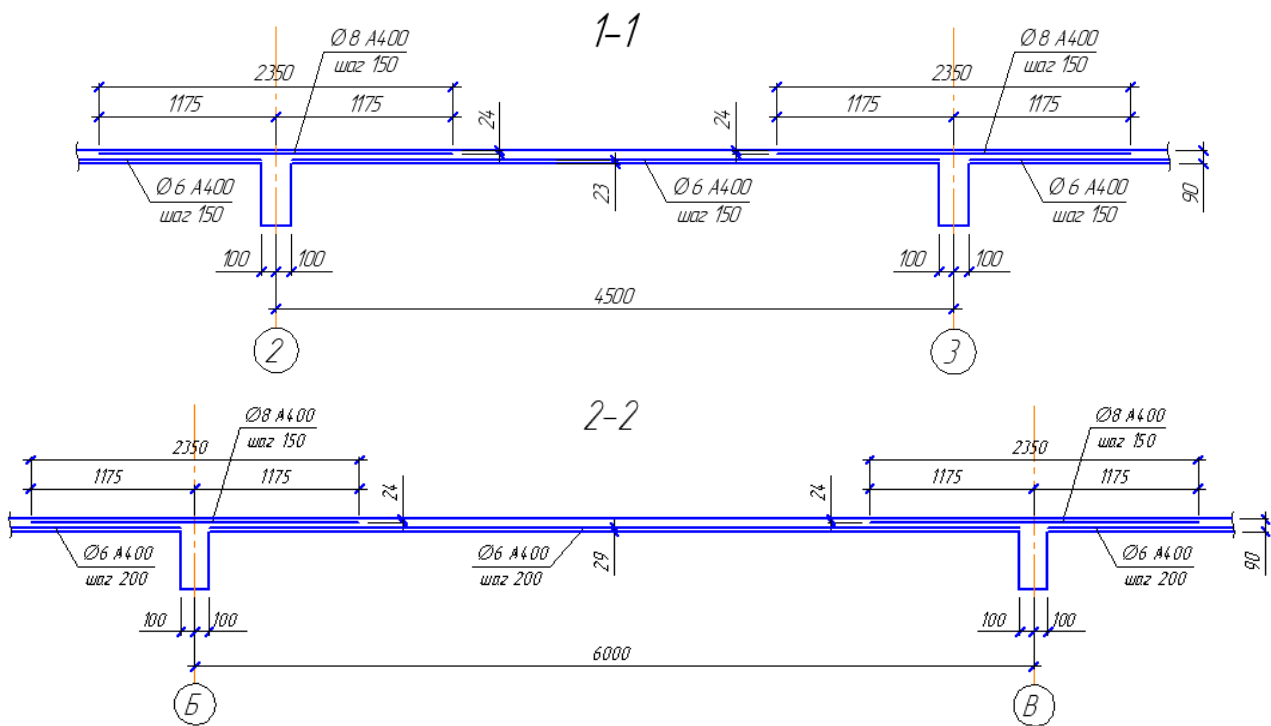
Разрезы 1-1 и 2-2 (арматура балок не показана)
